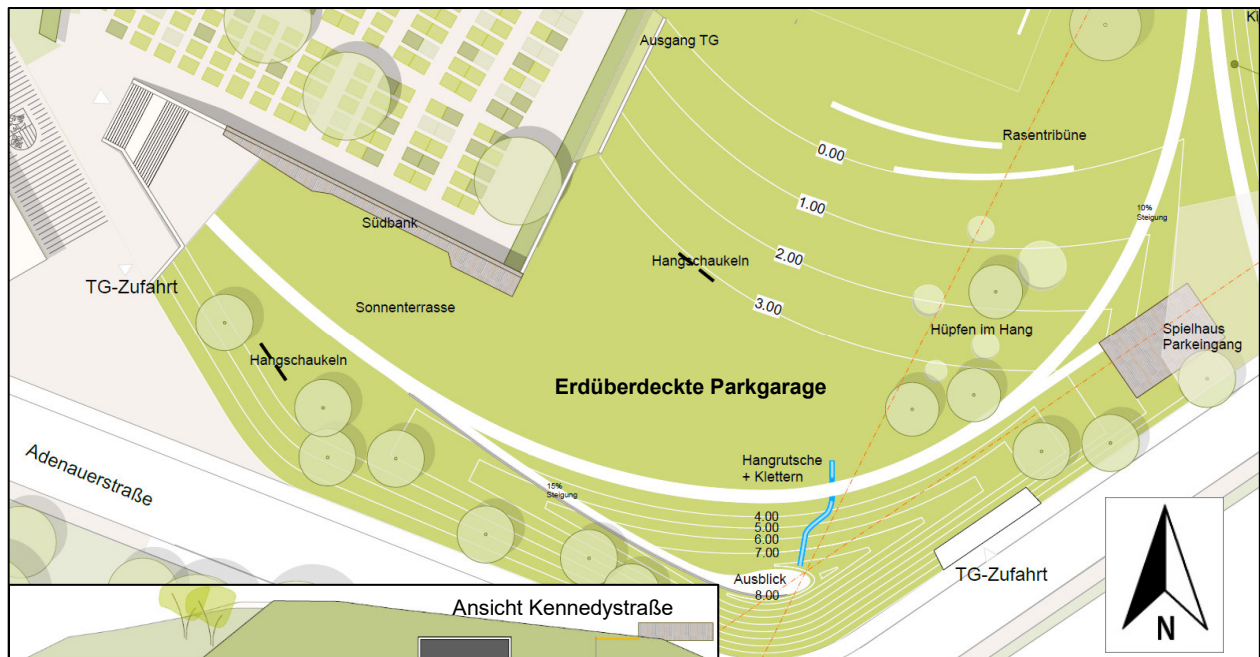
Südostteil Planungsbereich, Südteil Grundstück Fl.-Nr. 1568/28 und Ostteil Grundstück Fl.-Nr. 1568/3, geplanter Bau einer Parkgarage mit Spielplatz (Ausschnitt, Quelle /7/). Kein spezifischer Maßstab; maßstäblich siehe Anlage 1.3.
